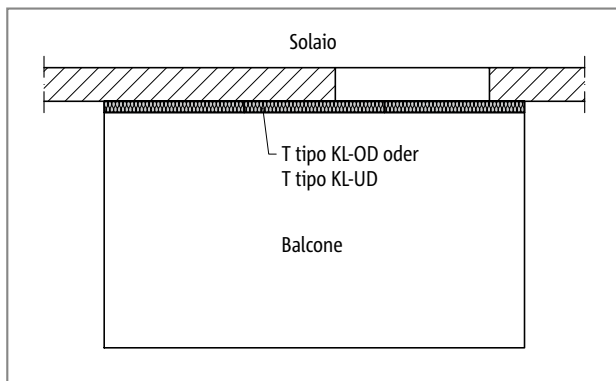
Schöck Isokorb® T tipo KL-OD/UD: balcone a sbalzo
